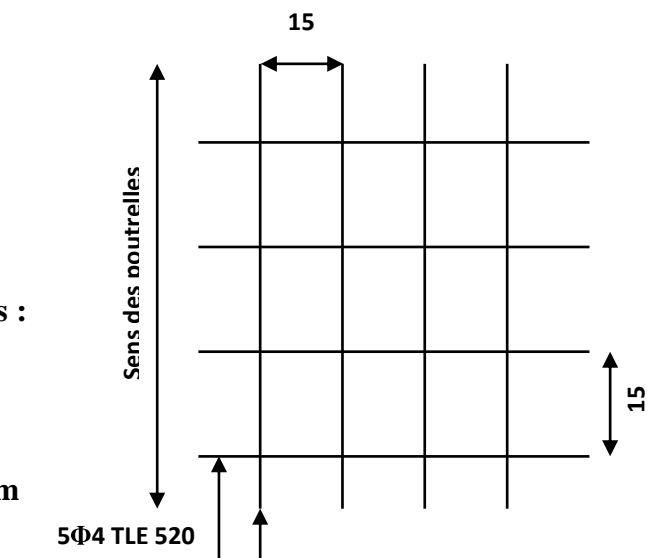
Ferrailage de la dalle de compression avec un treillis soudé
